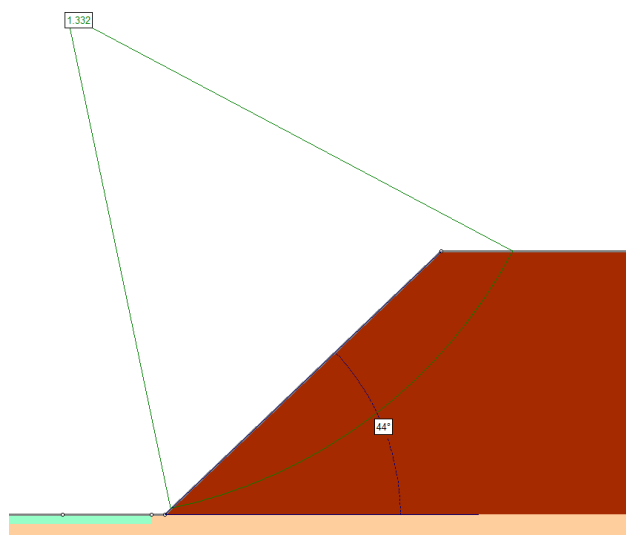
Seção de cálculo da escavação para remoção do muro existente.
